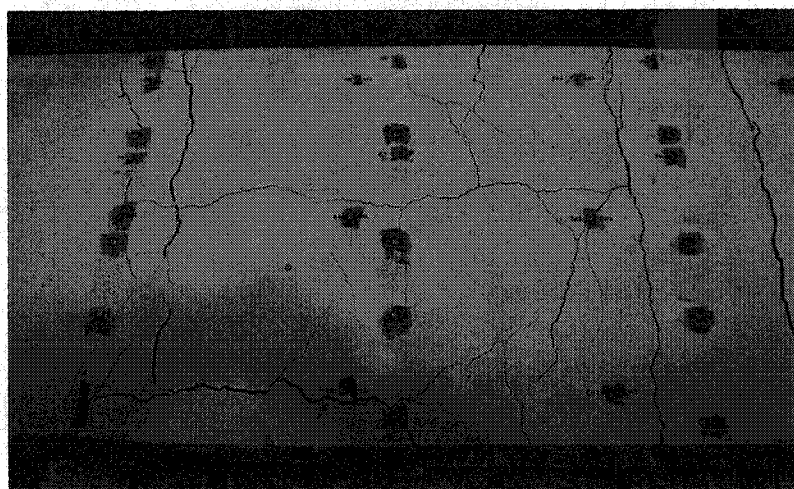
Patron de fissuration du spécimen R1
